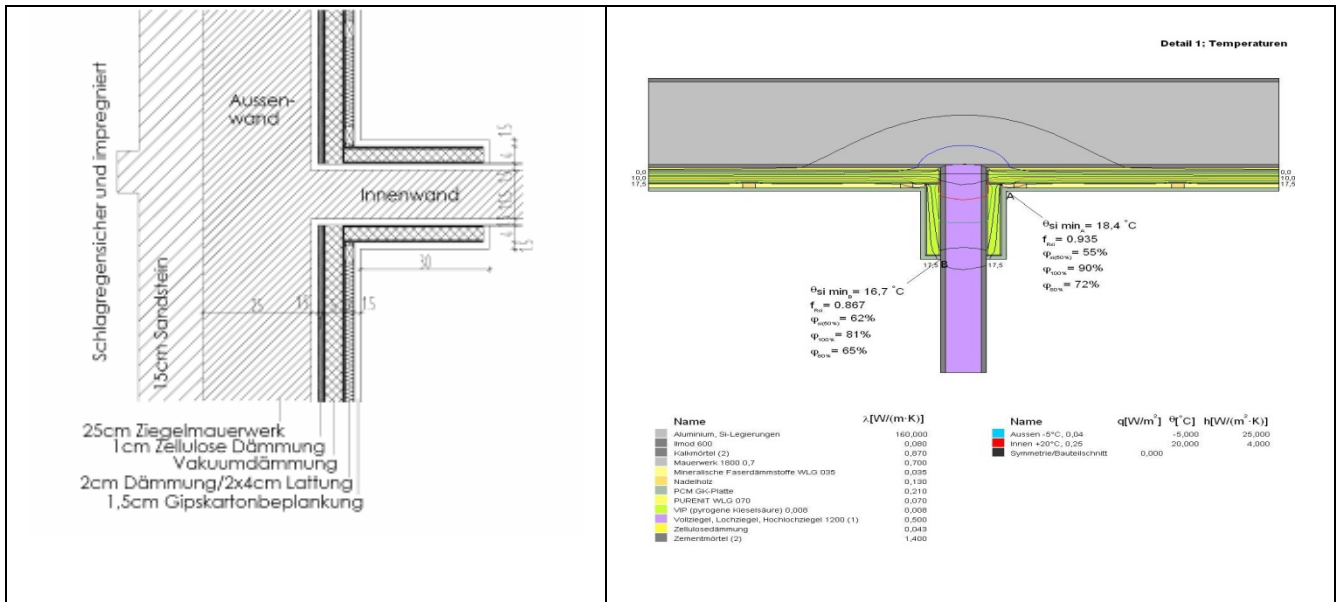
Detailaufbau von 1870 – 1920 Außenwand
